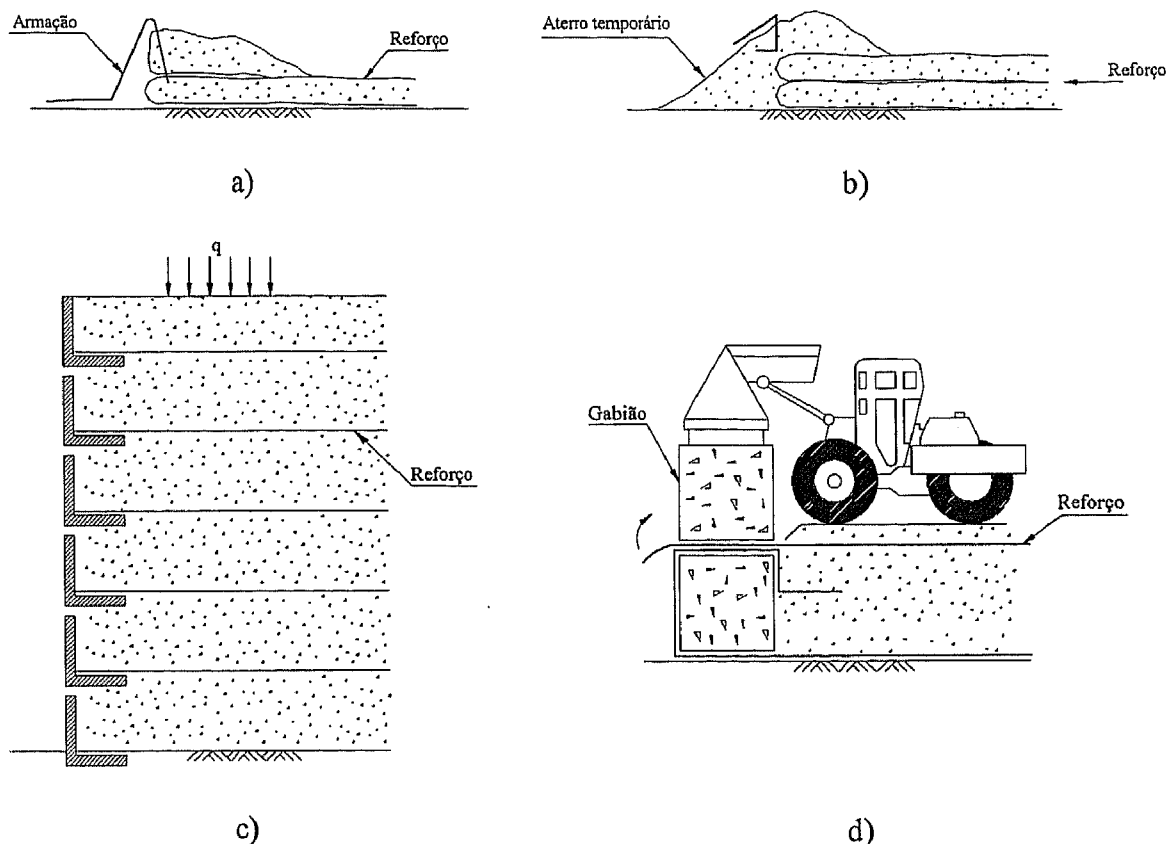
Algumas técnicas aplicadas na construção incremental de estruturas de face vertical reforçadas com geossintéticos: a) utilização de armação durante a construção; b) utilização de aterro temporário durante a construção; c) elementos de face em betão pré-fabricado; d) elementos de face em gabiões.
